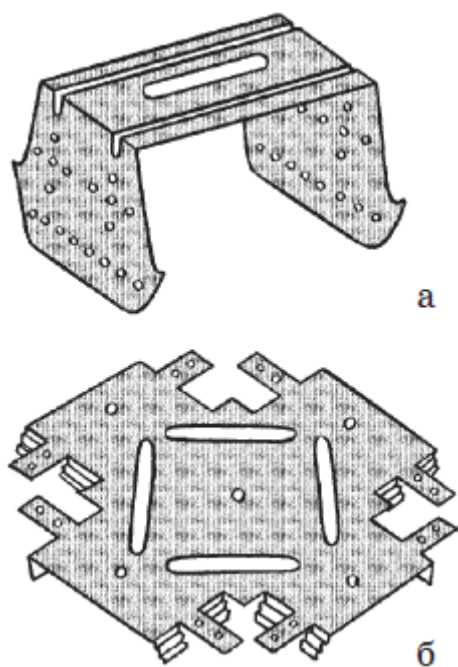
Соединитель для крепления несущего профиля к основному: а – двухуровневый; б – одноуровневый
